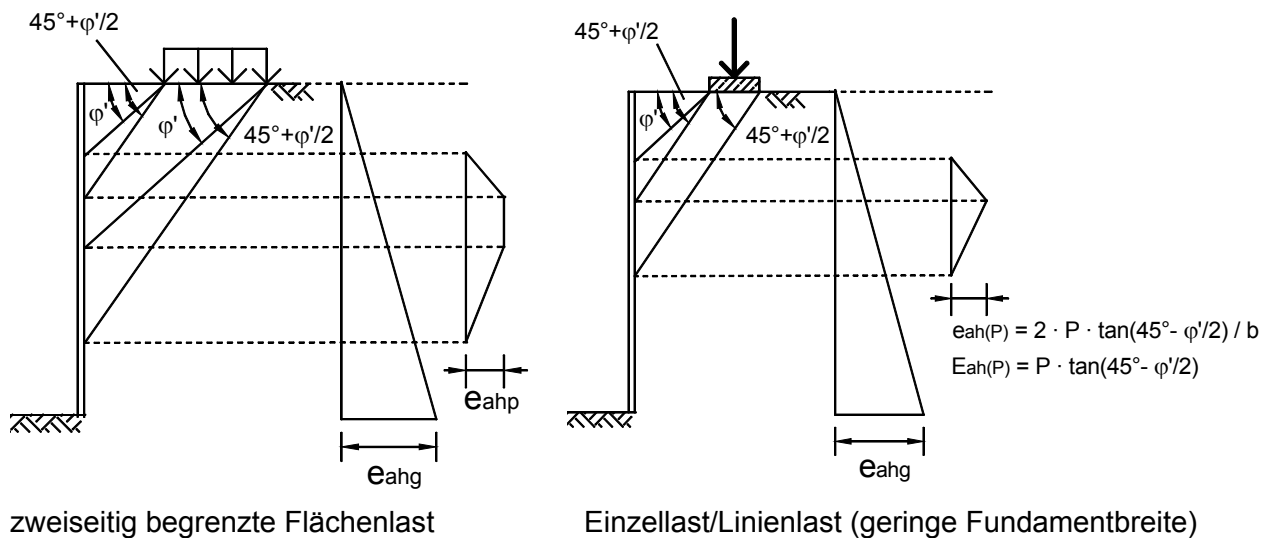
Erddruckverteilung infolge oberflächennaher Lasten
